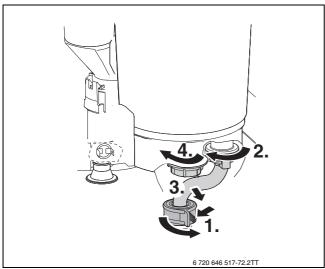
Mutter entfernen und Rücklaufrohr lösen
